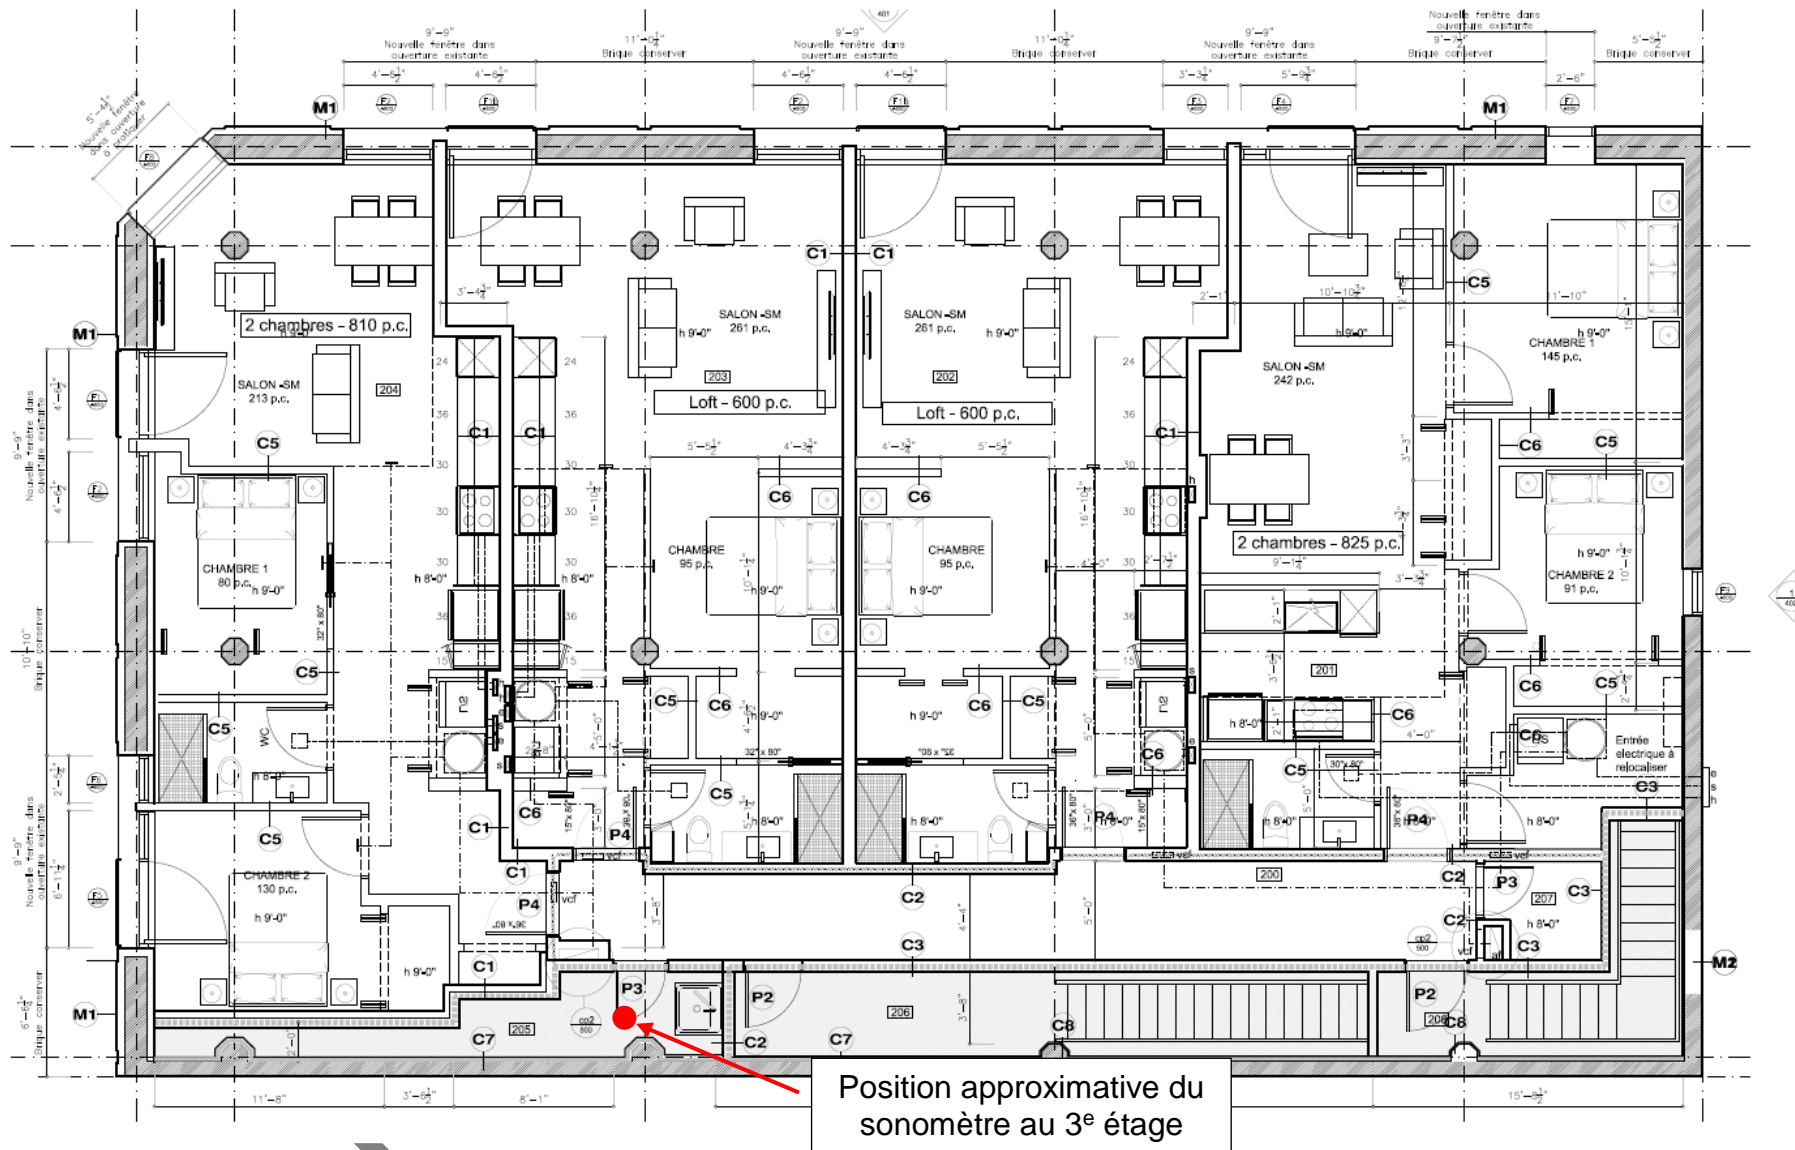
Plan d'aménagement du 3^e étage du projet immobilier
